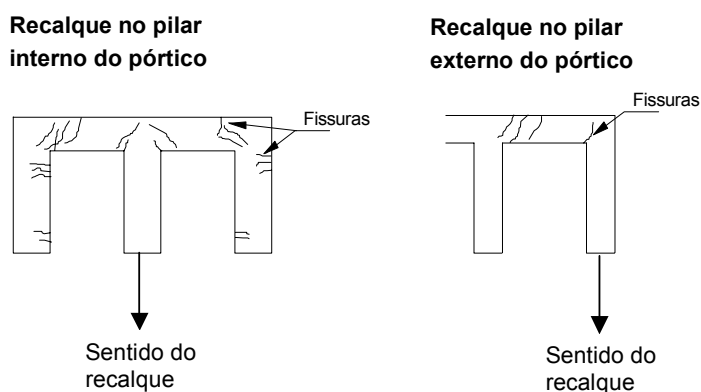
Recalques de estruturas de concreto armado em pórticos
